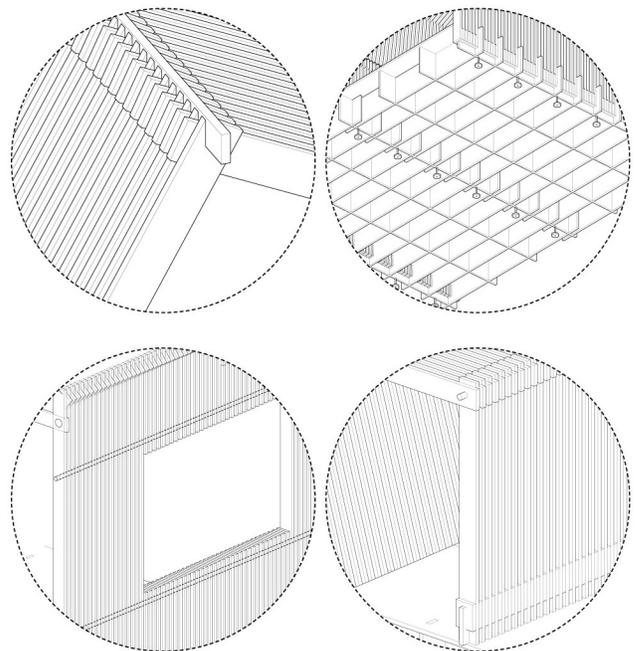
Detalhes construtivos da cumeeira e piso (acima), e aberturas laterais e mobiliário (abaixo)
